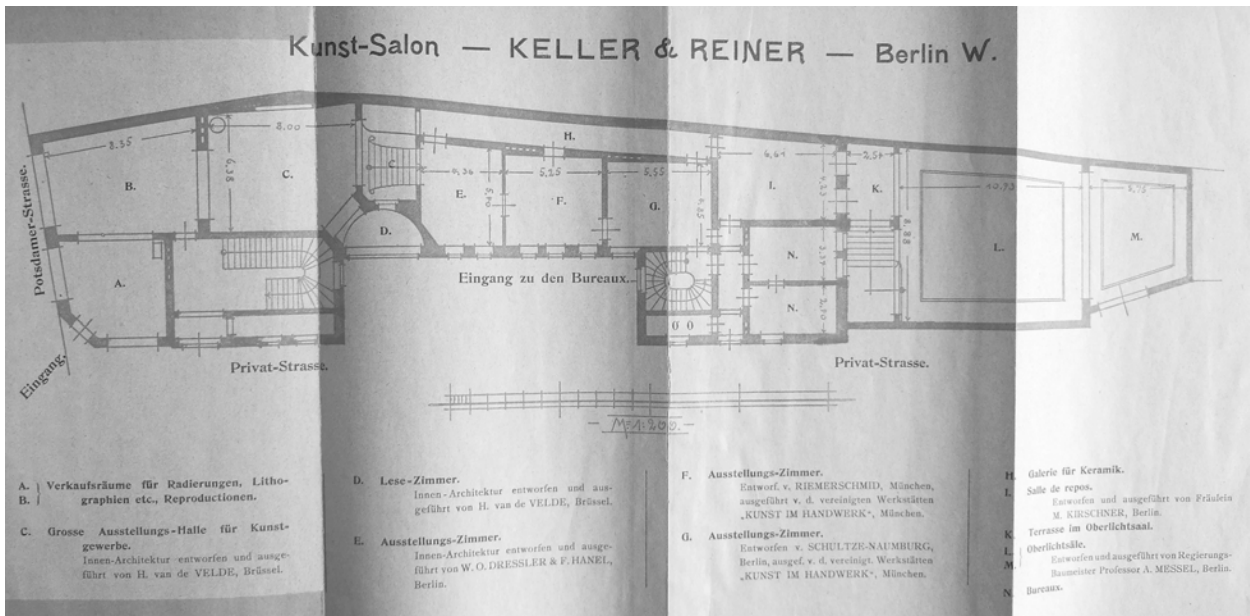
Grundriss von Keller & Reiner nach Umbau 1898. Die drei Ausstellungsräume der Dauerausstellung sind mit den Buchstaben „E“, „F“ und „G“ bezeichnet.
